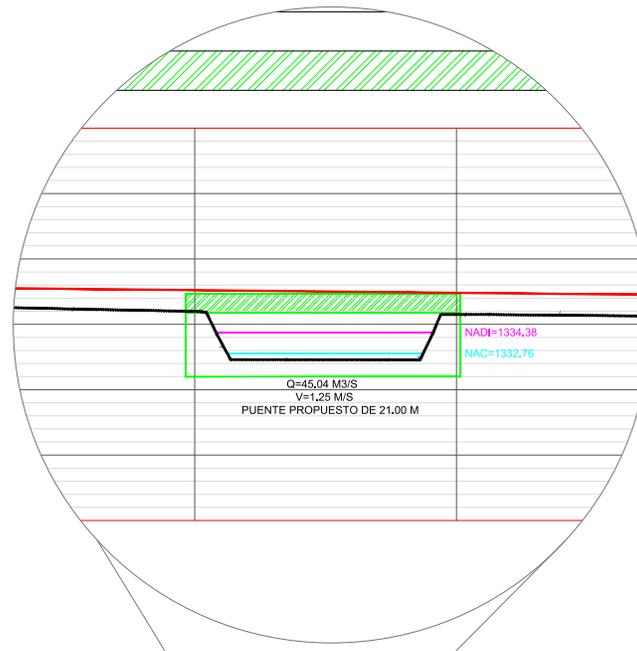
Perfil detallado de la sección de cruce y nivel de la rasante
